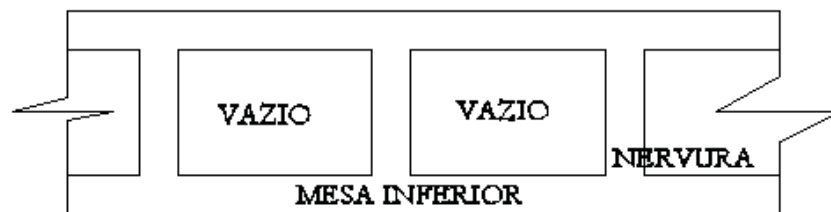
Modelo de laje nervurada dupla (FONTE: Autor)
